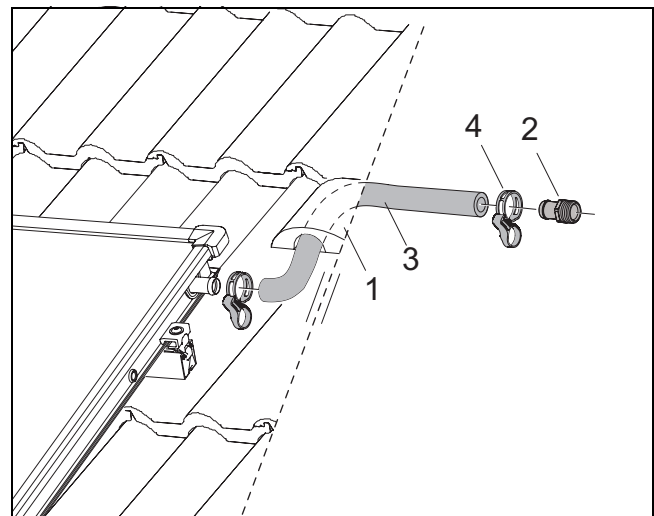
Монтаж подающей линии (без воздушного клапана на крыше)
